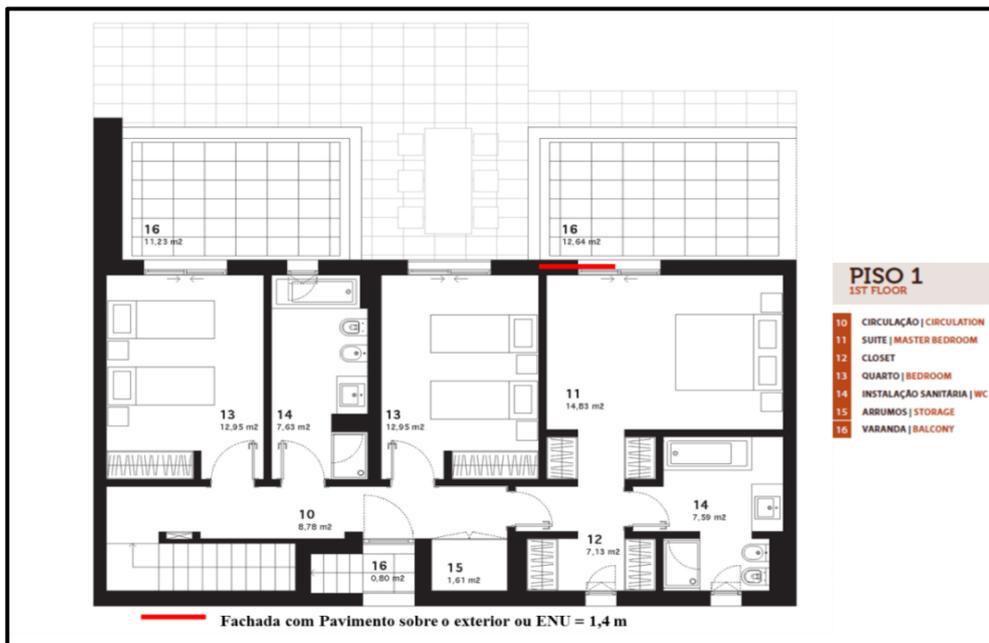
PTL – Fachada com Pavimento sobre o Exterior ou ENU
